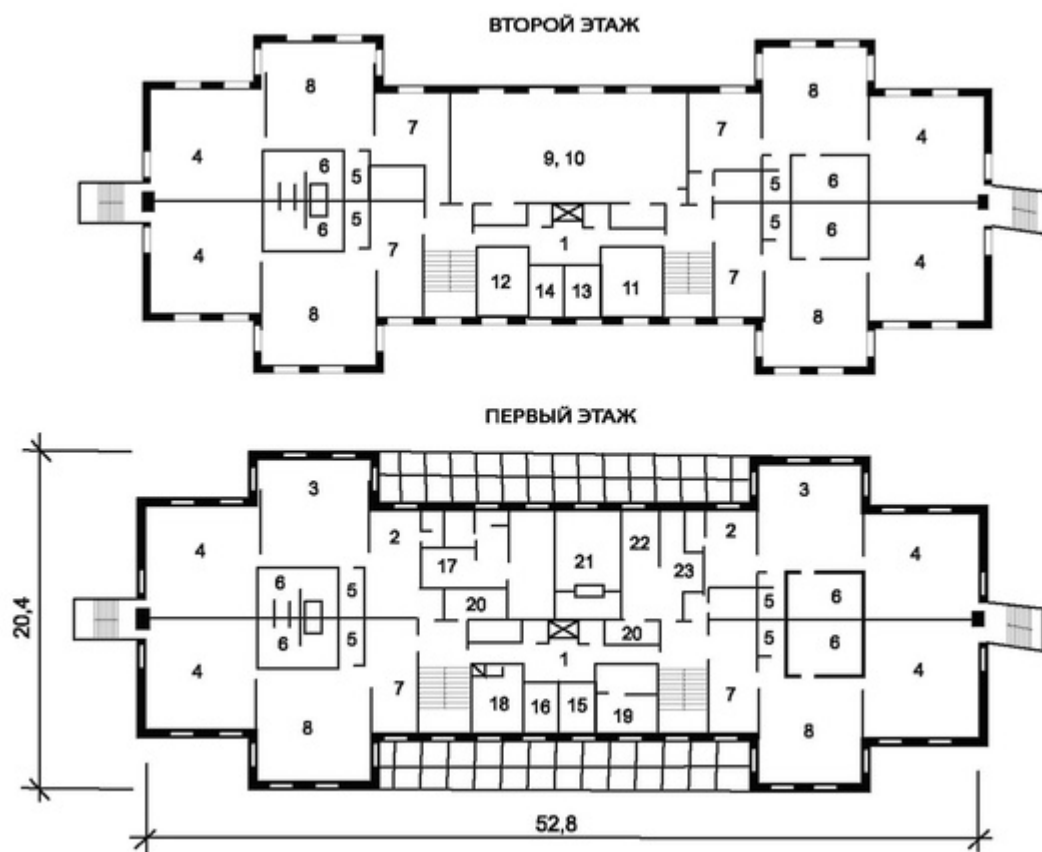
Планы первого и второго этажей яслей-сада на 190 мест: 1 - холл; 2 - приемная; 3 - игровая; 4 - спальня; 5 - буфетная; 6 - туалетная; 7 - раздевалка; 8 - групповая; 9 - зал для физкультурных занятий; 10 - зал для музыкальных занятий; 11 - методический кабинет; 12 - логопедический кабинет; 13 - кабинет заведующей; 14 - комната завхоза; 15 - медицинская комната; 16 - процедурная; 17 - кастаньянская; 18 - комната персонала; 19 - изолятор; 20 - кладовая чистого белья; 21 - кухня с подсобными помещениями; 22 - прачечная; 23 - гладильная
